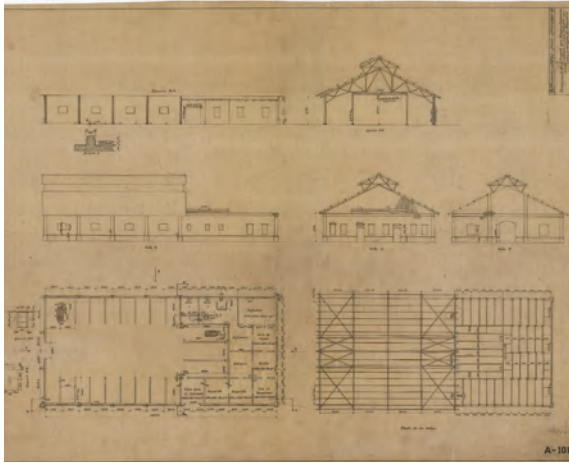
Plano A-1017 Proyecto para Garage y Enfermería, empleando la misma armadura que para la ampliación de Maquinaria. Monterrey, N.L., sin fecha. Planoteca-Archivo Histórico Fundidora.
